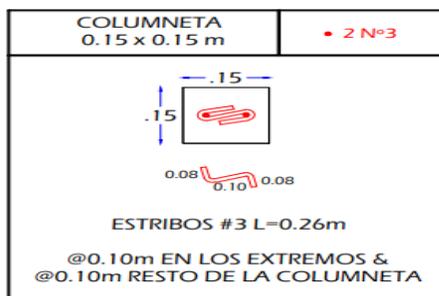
Despiece de estribo de columneta 0.15x0.15
